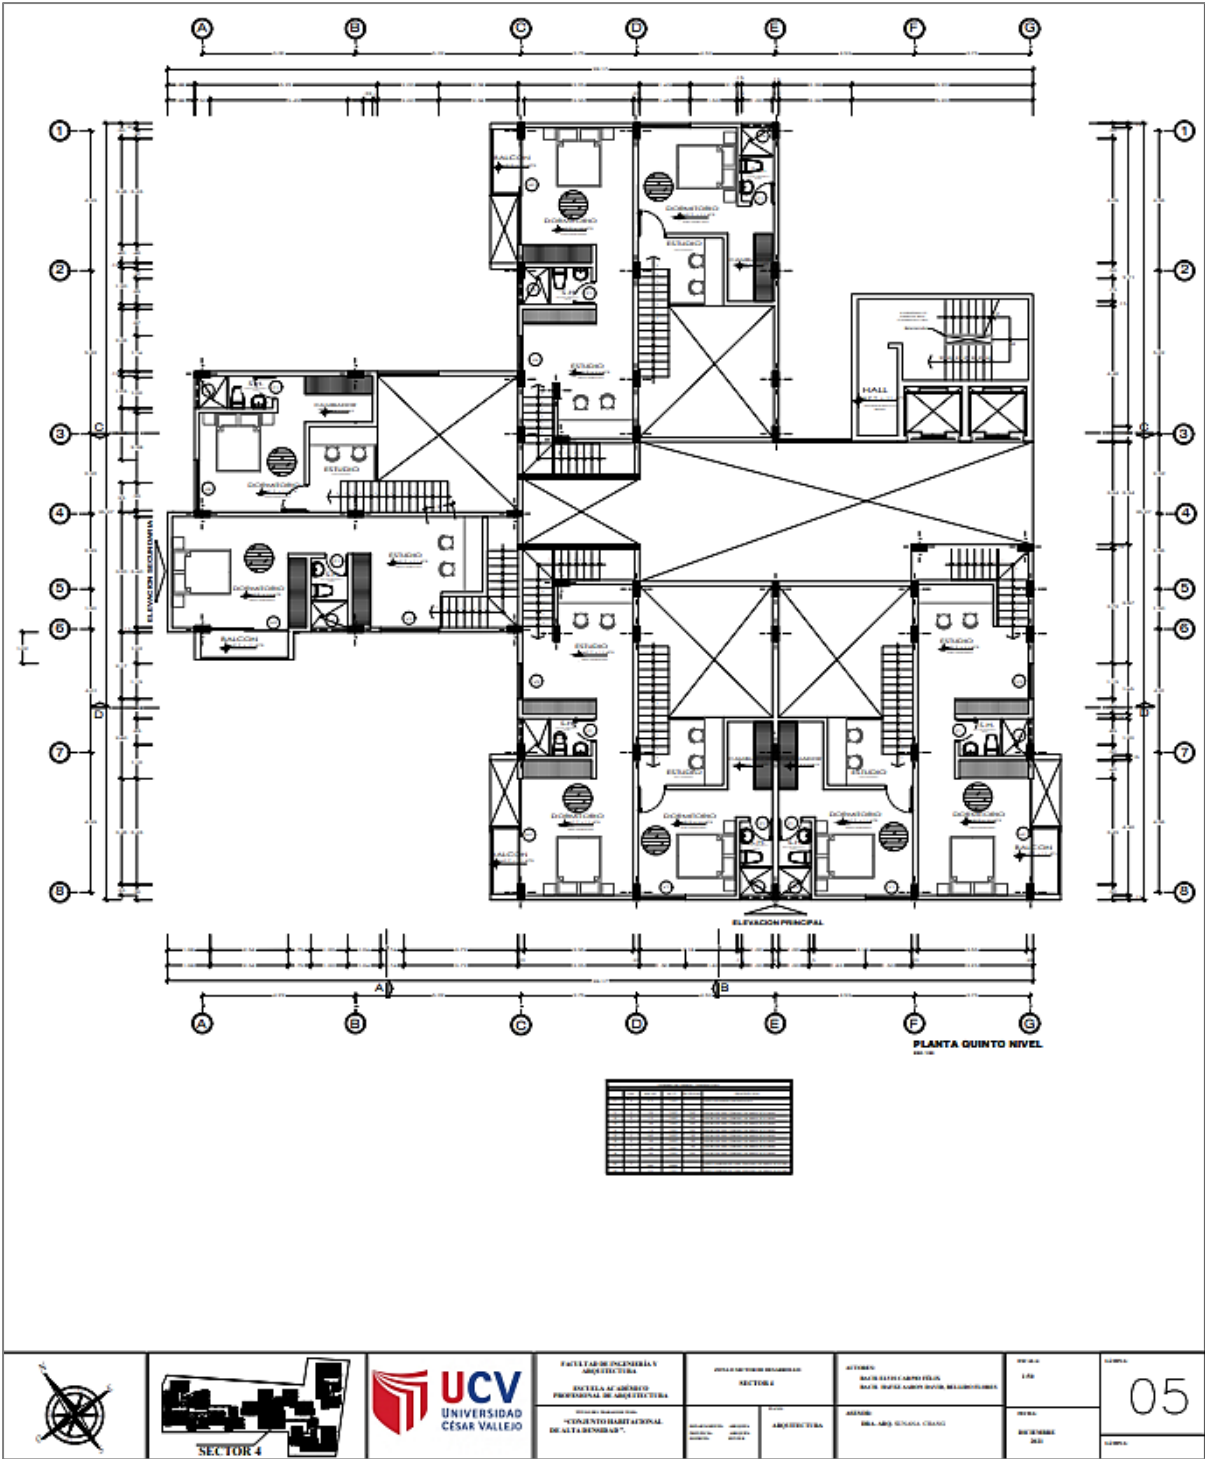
Planos de Arquitectura – 05 - Bloque 4 – Quinto Nivel
